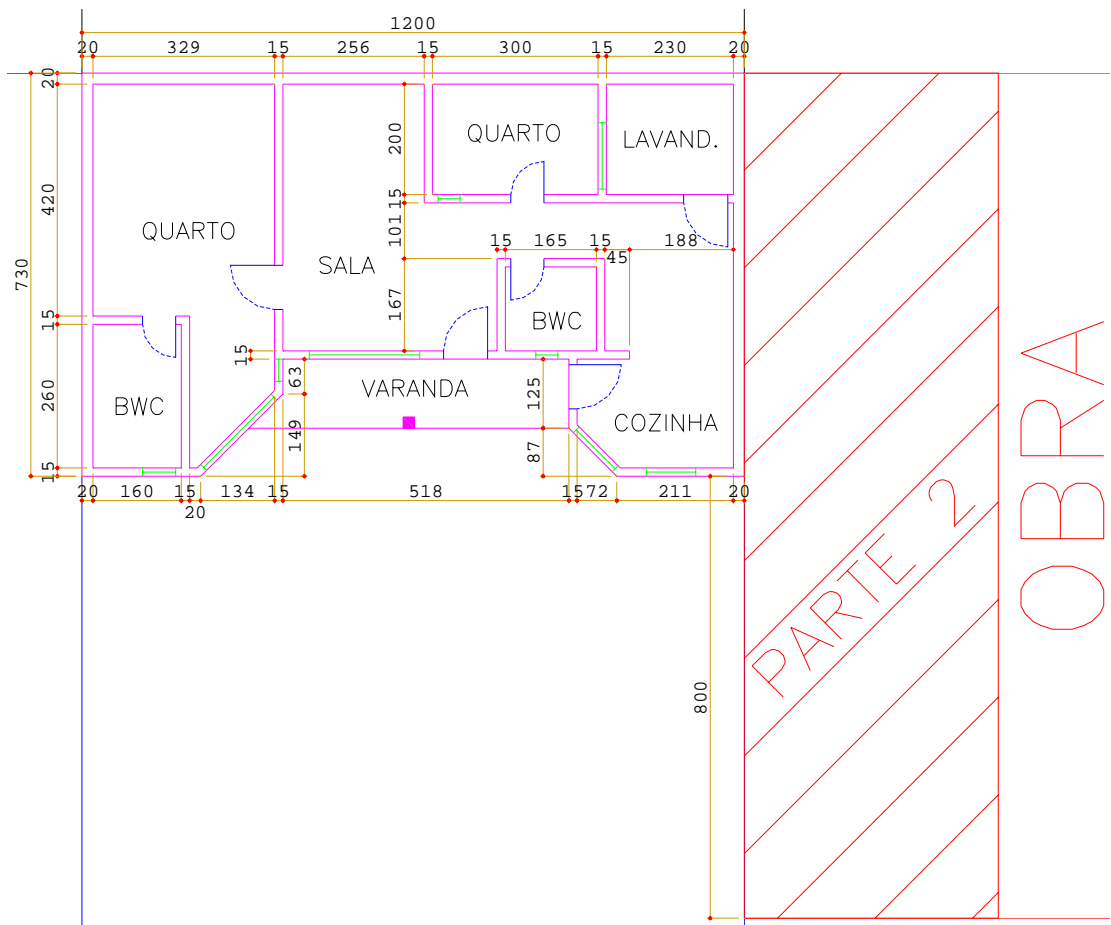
Planta da casa examinada (cotas em cm), cuja parede lateral direita é adjacente à parte 2 da obra de construção civil em execução.
